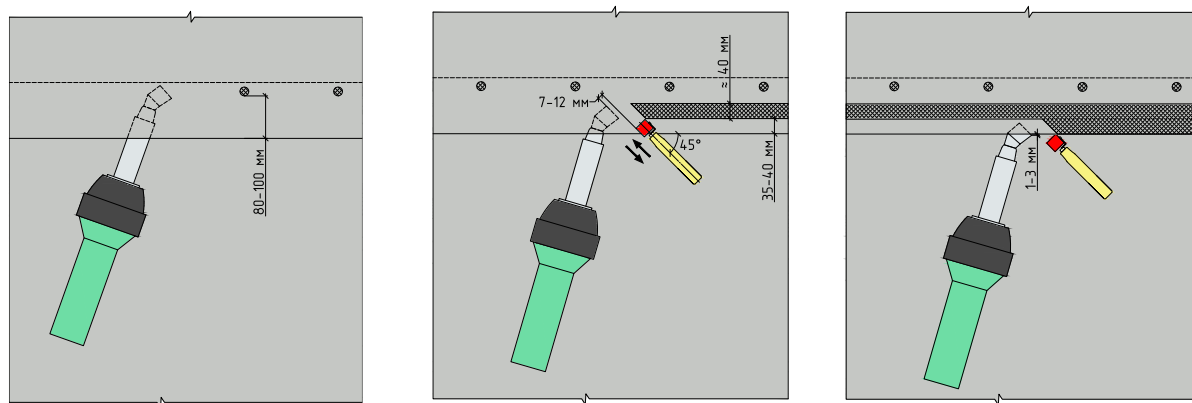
Порядок формирования сварного шва при помощи ручного оборудования
